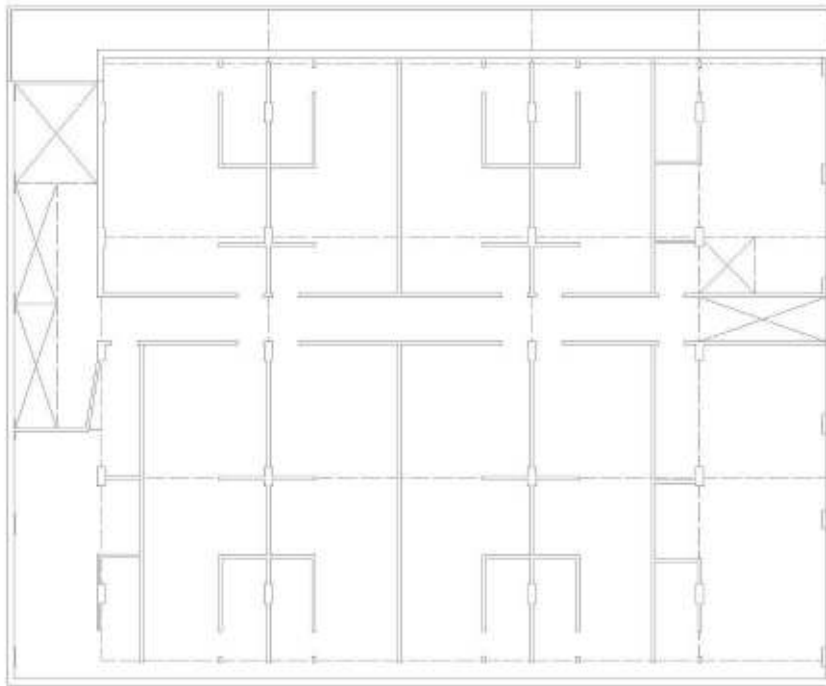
Planta baixa do 5. pavimento (trabalho não publicado¹²)
